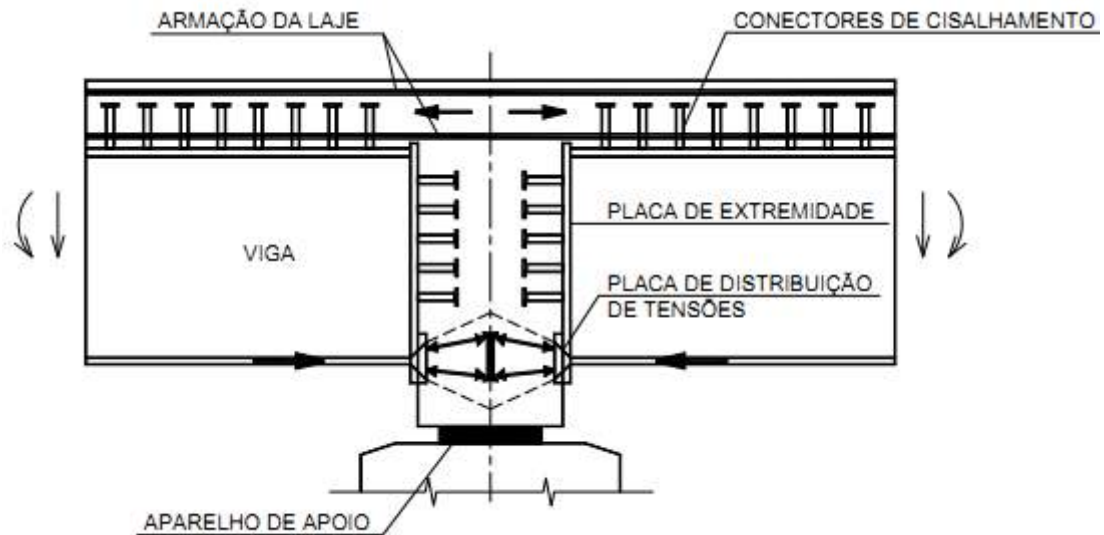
Solução de continuidade entre vigas por meio de emenda com transversina de concreto armado. Fonte: HECHLER, SOMMAVILLA (2009), adaptado.
